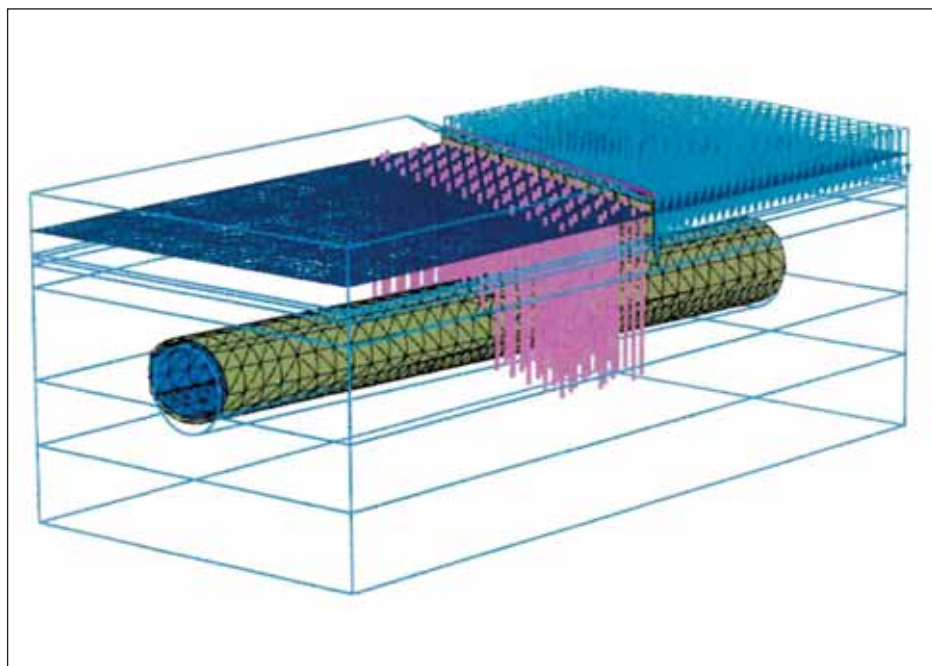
Расчетная схема перегонного двухпутного тоннеля, при пересечении водной преграды и намывной территории с грунтощебеночными сваями
